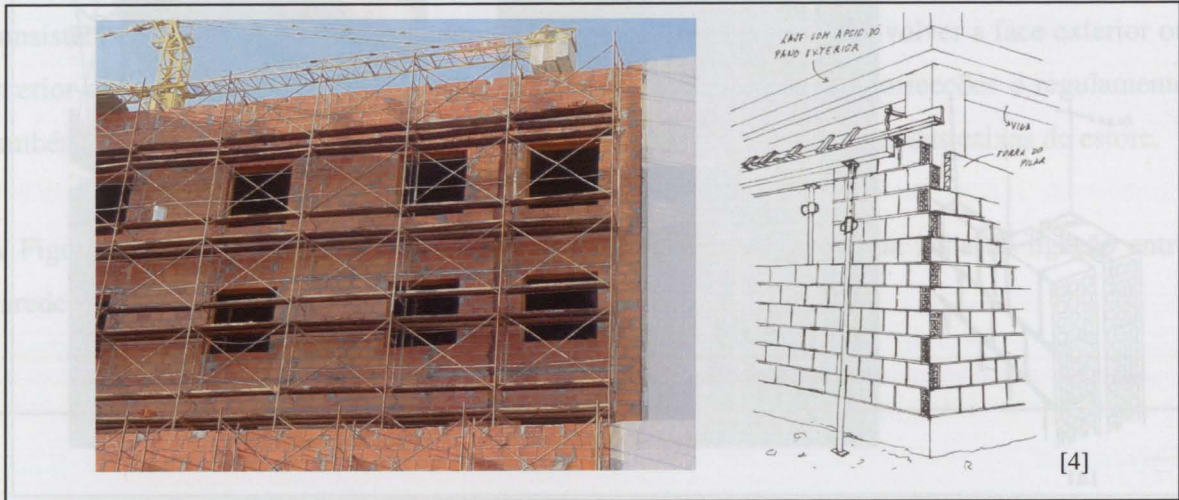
Perspectiva de edifício em construção com recobrimento da estrutura resistente com forras cerâmicas de tijolo furado
